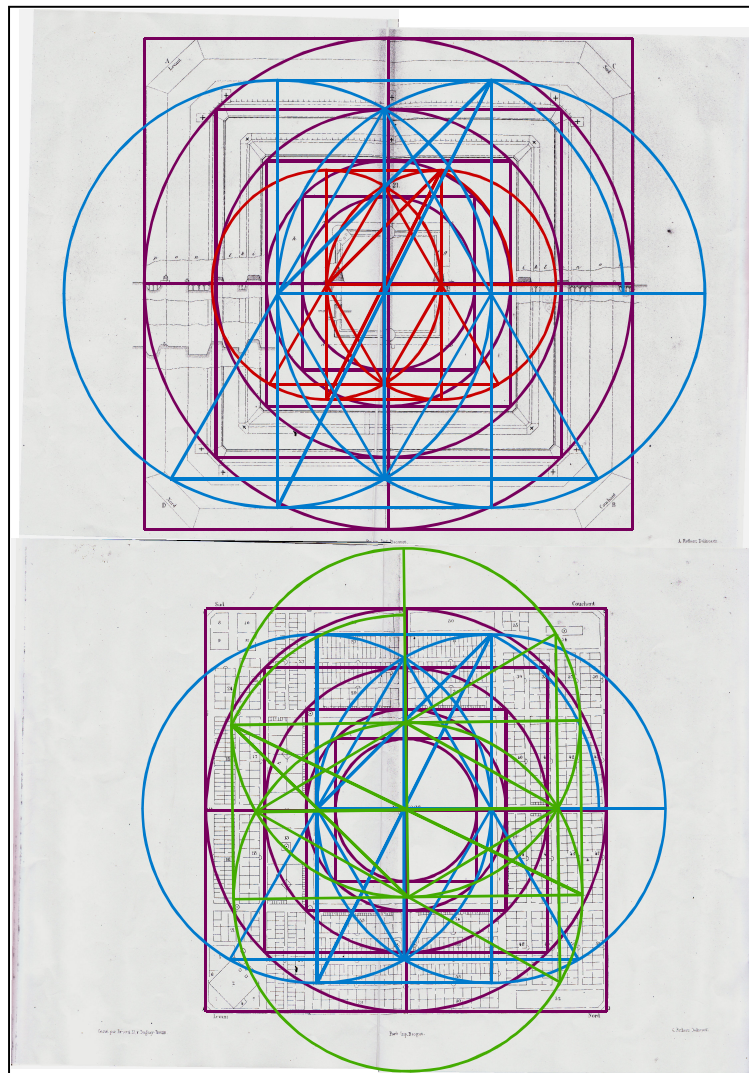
Planta de recinto amuralhado e Planta da disposição interior da cidade fortificada. Instalação de diagramas Mandalas e Vesica Piscis. Ibidem, Imagens nº 21 e 22..
